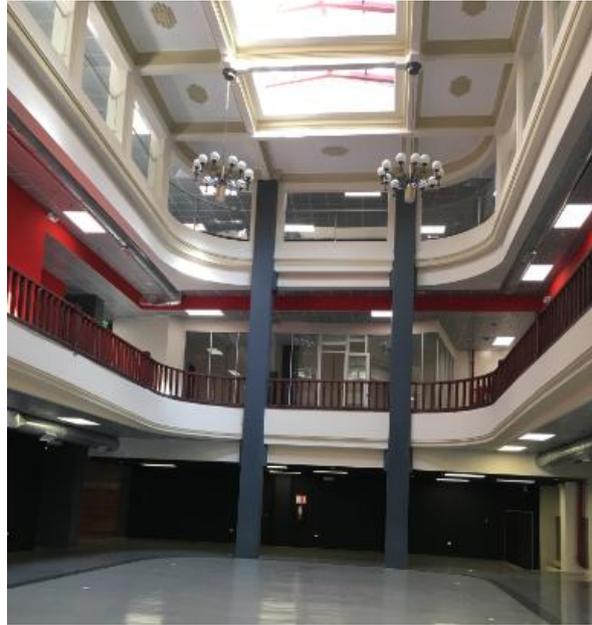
En todas las fotos que se observan las columnas y muros pintados de negro, son los que se han colocado para reforzar la estructura.
